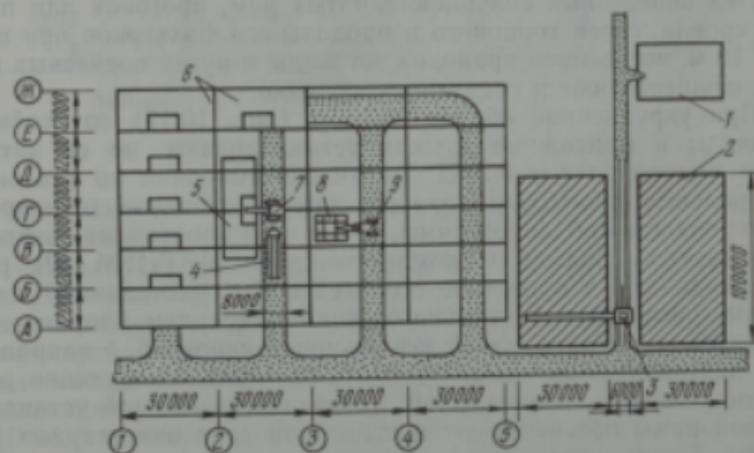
Стройгенплан при монтаже блоков покрытий, собранных на стенде: 1 — стройгородок; 2 — склад стальных конструкций; 3 — кран КП-300; 4 — КрАЗ с полуприцепом для перевозки ферм; 5 — блок покрытия на стенде; 6 — смонтированные блоки; 7 — кран СКГ-63/100; 8 — стенд для сборки карт профилированного настила; 9 — кран МКГ-16М
